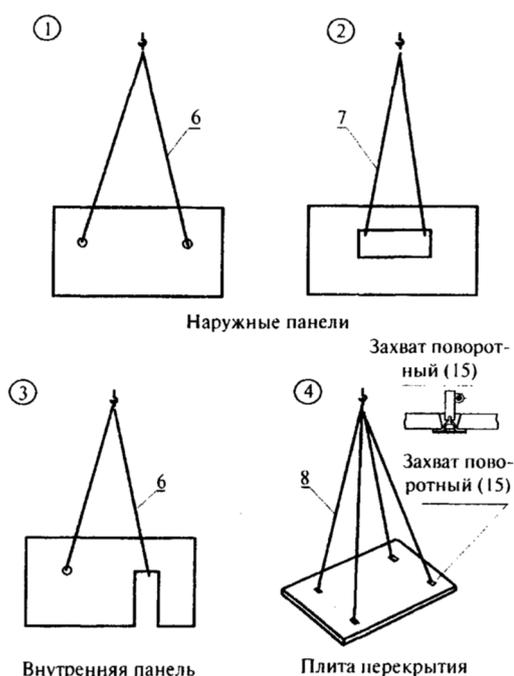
Схемы строповки железобетонных плит при демонтаже краном.
